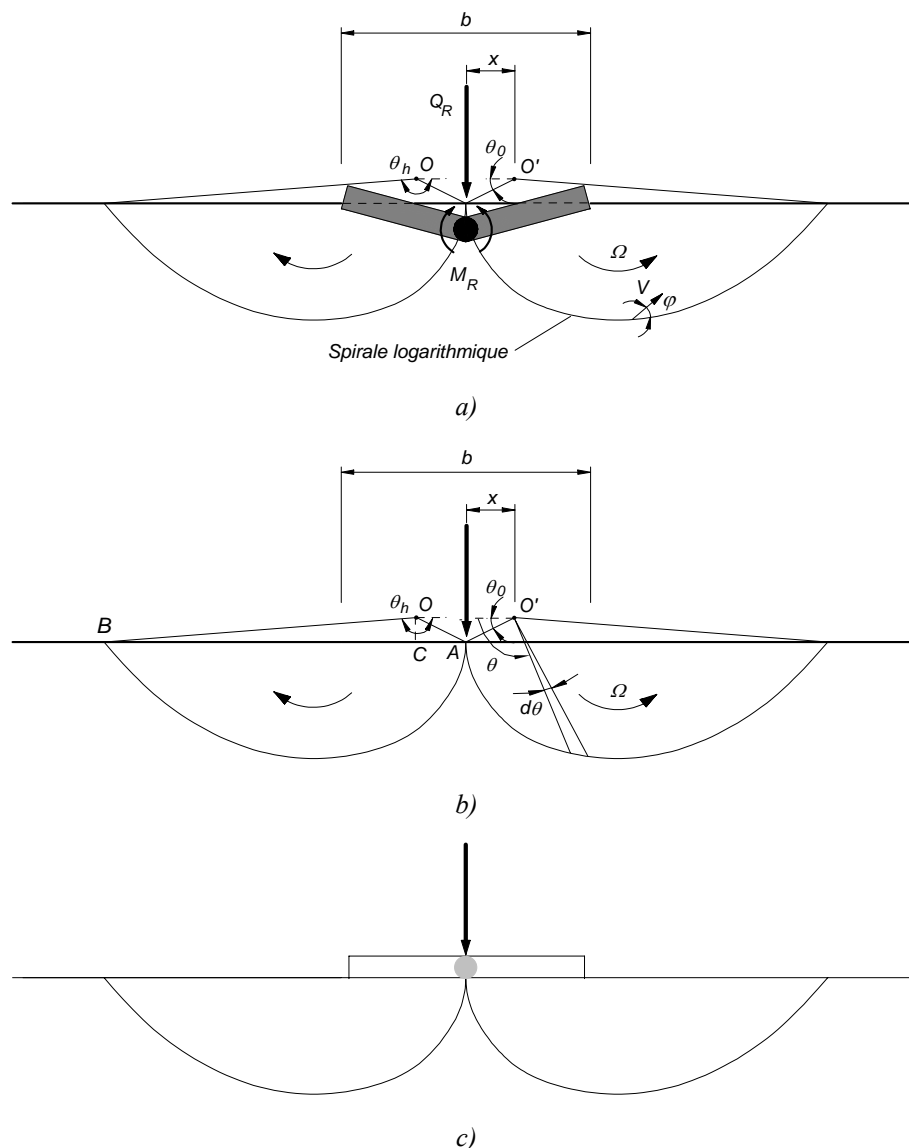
Mécanisme de rupture avec rotule plastique dans le cas d'une fondation infiniment longue sur sol frottant pesant sans cohésion: a) sol et structure b) sol et c) zones de dissipation d'énergie (fondation parfaitement lisse)
